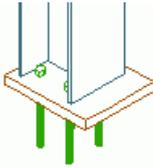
Assemblages Platine de pied de poteau asymétrique
